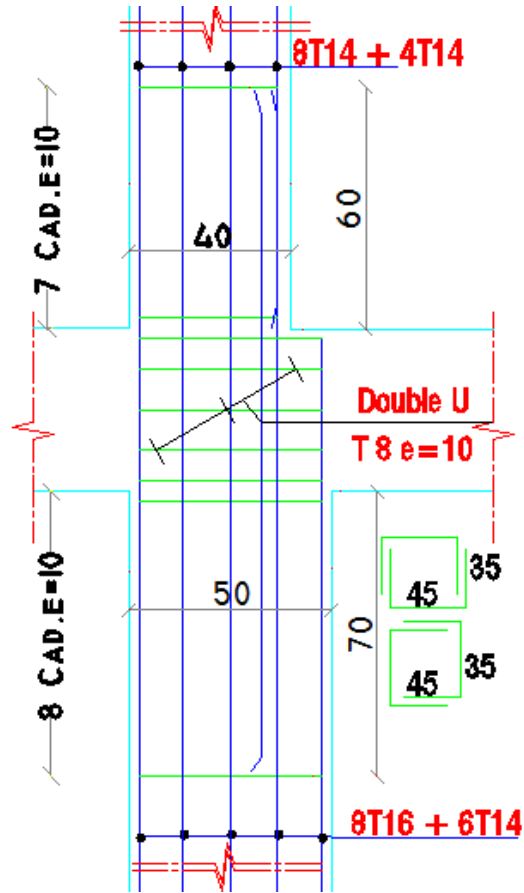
Ferrailage de recouvrement des poteaux (50x40) cm<sup>2</sup> et (40x40) cm<sup>2</sup>.
